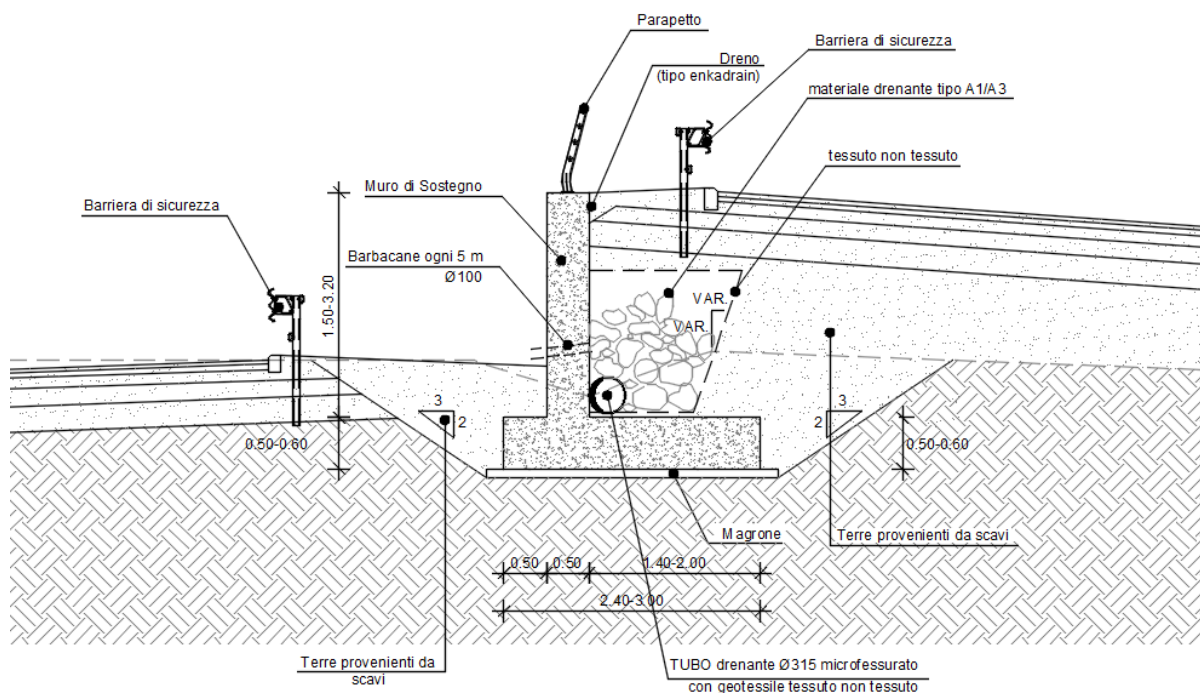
Muro Tipo A – Sezione trasversale tipo
